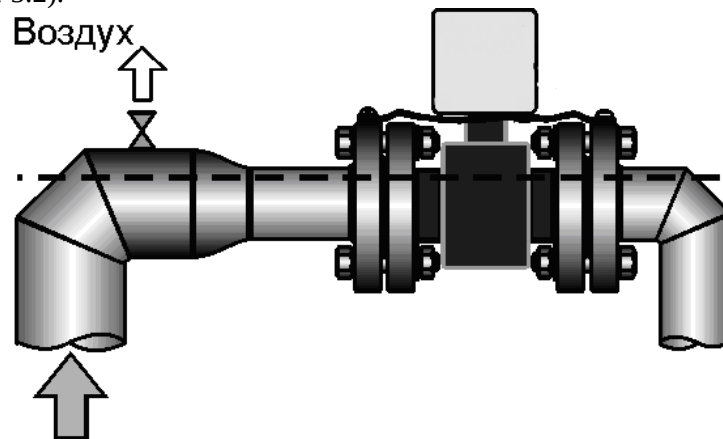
Установка ИТЭМ в верхней точке трубопровода
